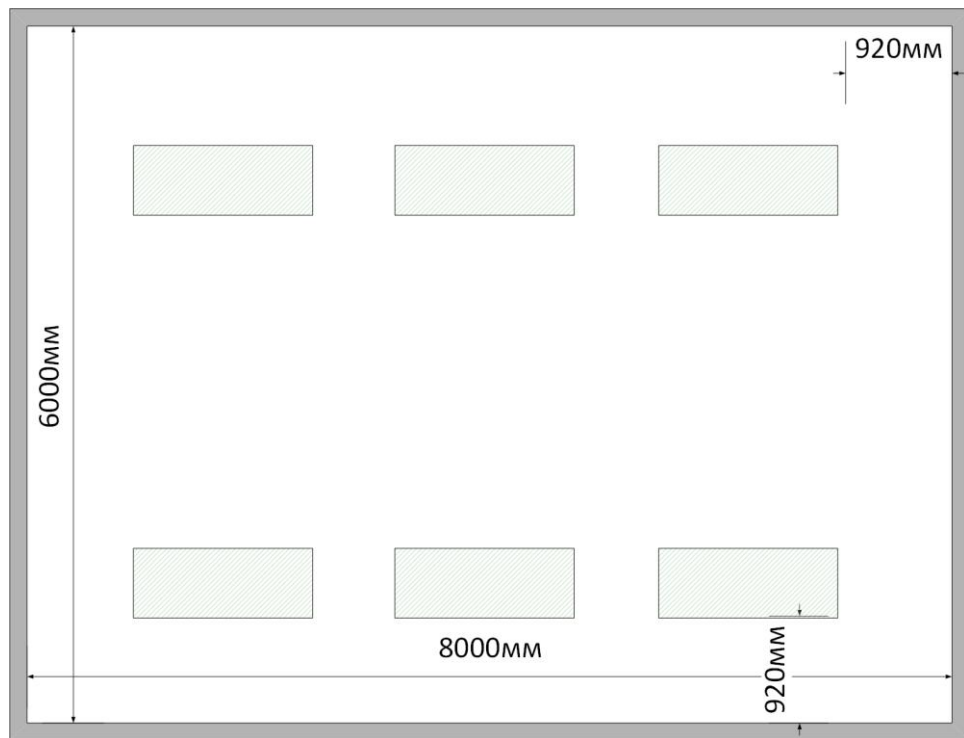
План помещения и размещения светильников с люминесцентными лампами
